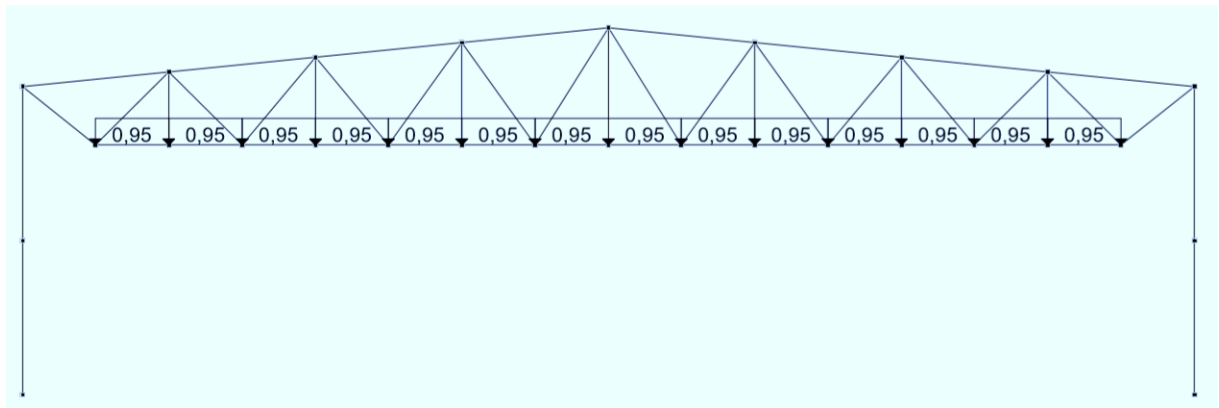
Схема прикладання завантаження № 3 «Тимчасове навантаження» на елементи каркаса будівлі
